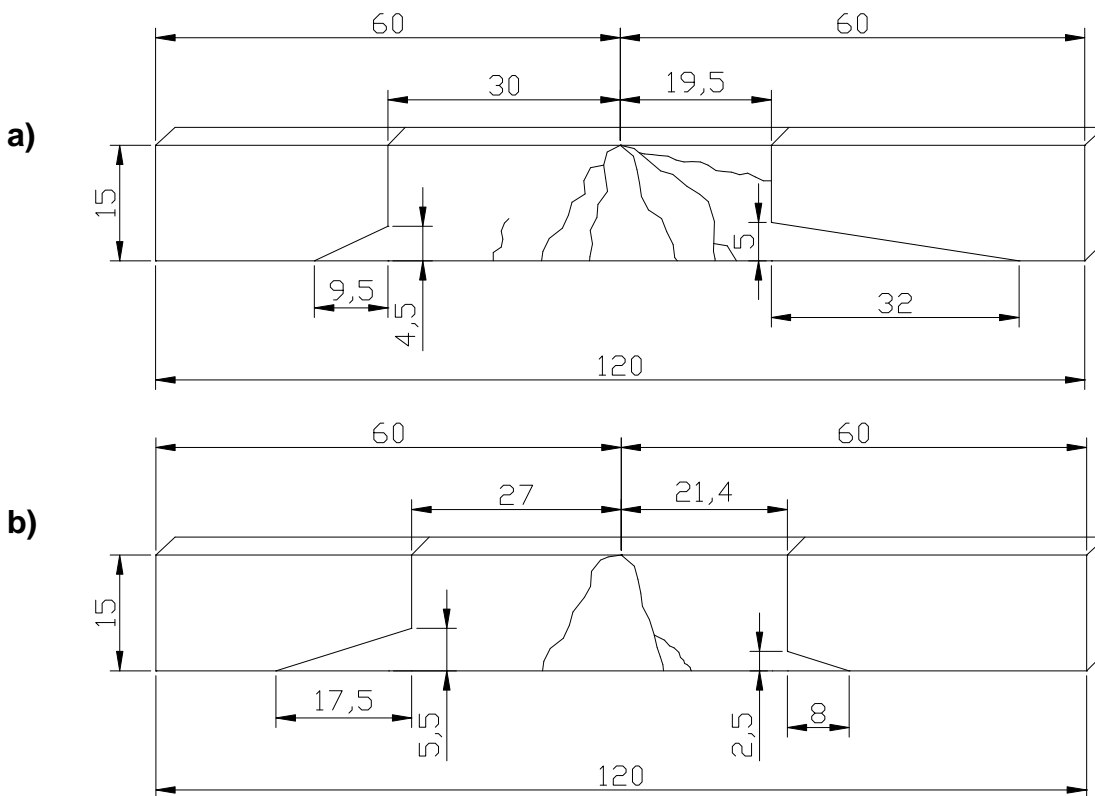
Esquema de fisuración de vigas después de la aplicación de carga mecánica. Medidas en cm. a) viga 7 b) viga 8
